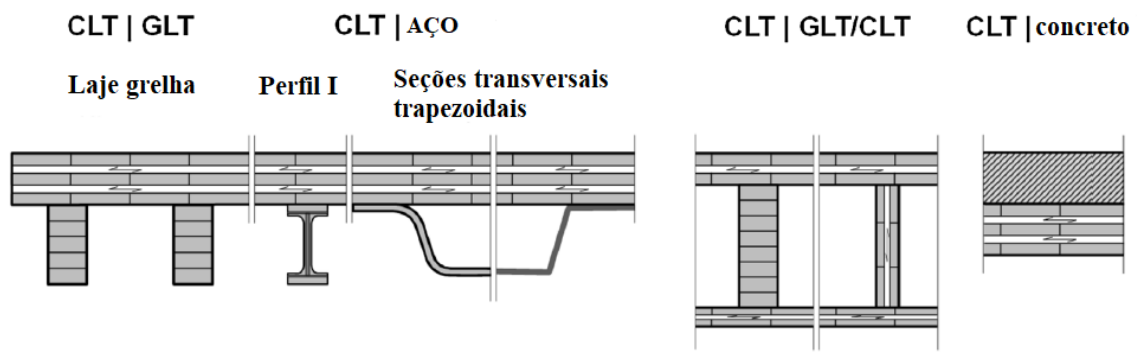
Aplicações do CLT: estruturas híbridas com concreto e aço.
